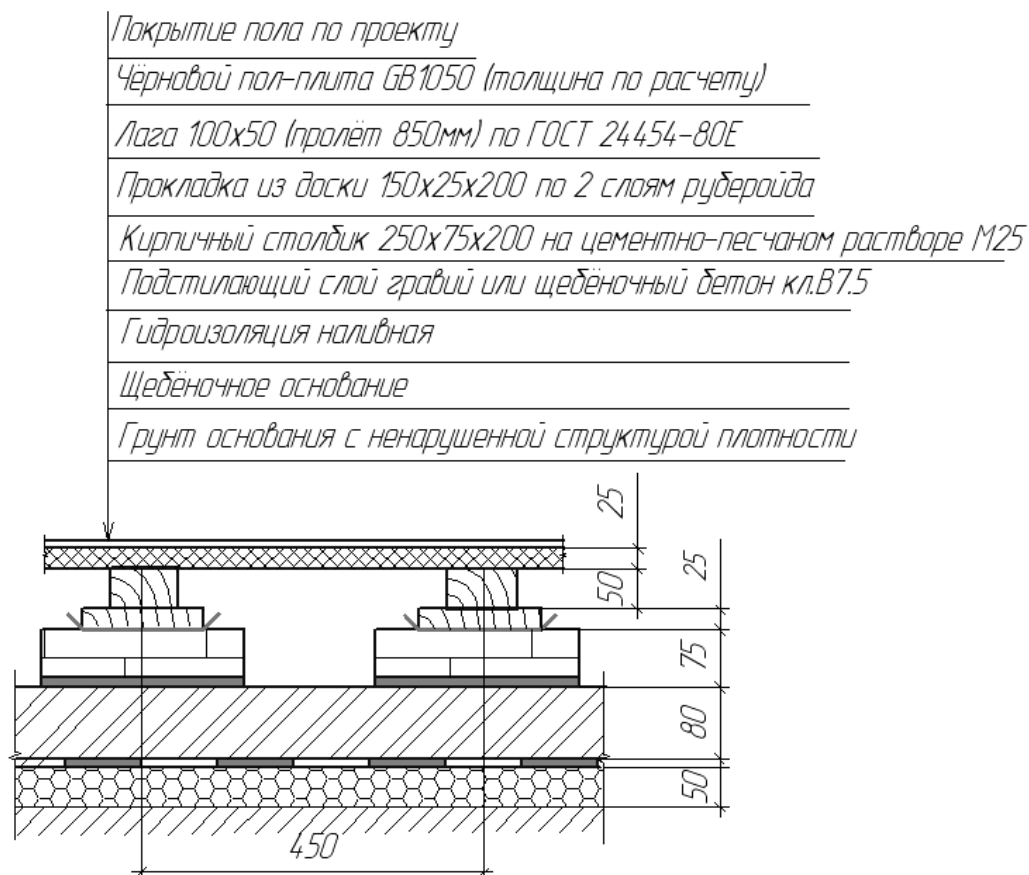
Конструкция пола по грунту с применением плит системы плит GREEN BOARD® без утепления с покрытием на деревянных лагах на щебеночном основании
